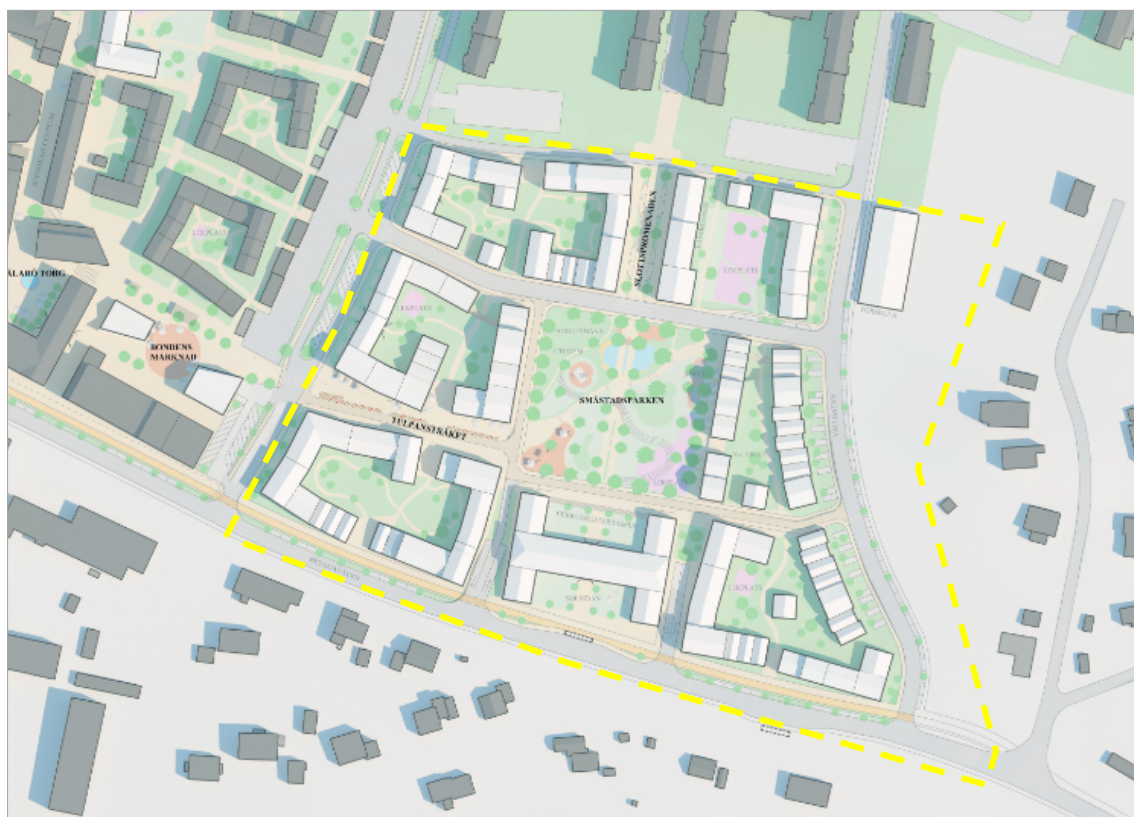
Illustration. Koncept till planhandlingar (Exerton, 2020). Gul streckad linje visar föreslagen plangräns.
